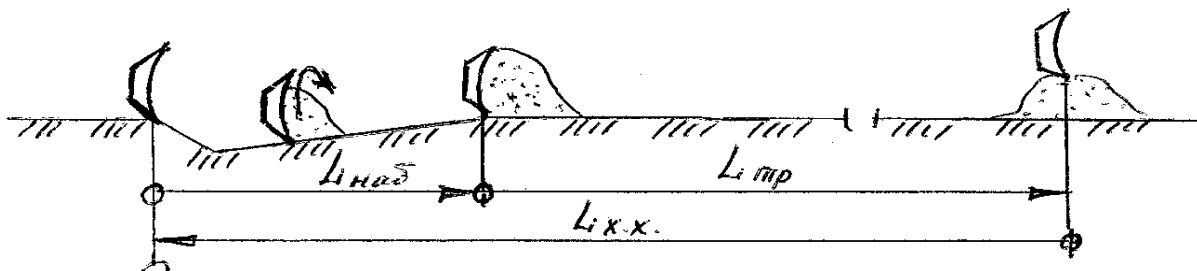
Элементы рабочего цикла разработки и перемещения грунта бульдозером:
